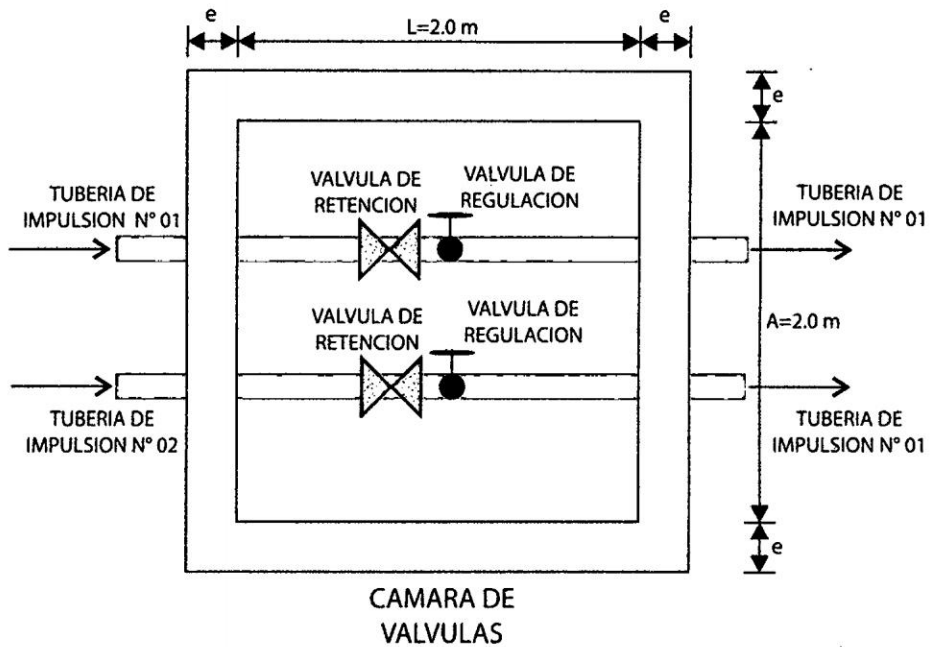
Vista en planta de la cámara de válvulas. Fuente: Elaboración propia
